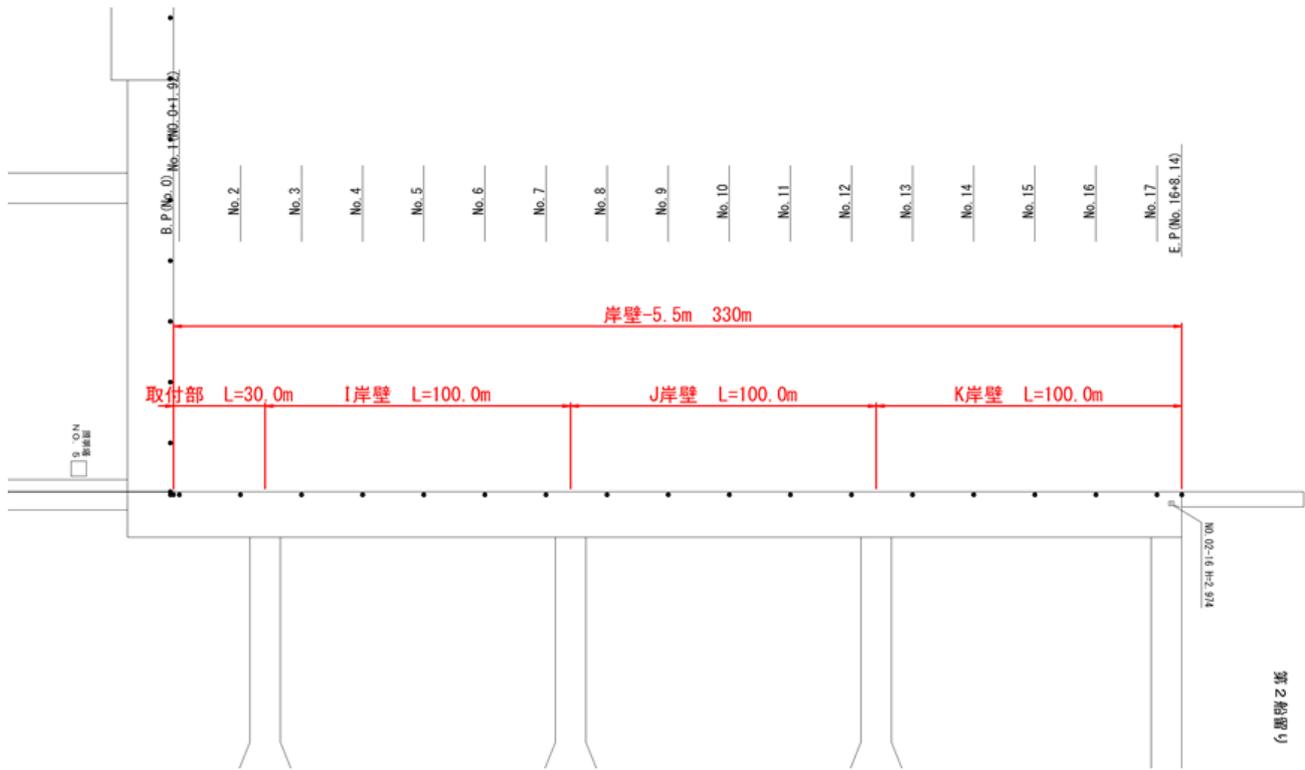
220 No.18 常陸那珂港区_北ふ頭地区岸壁 (-5.5m) I,J,Kの平面図 (被災前)
